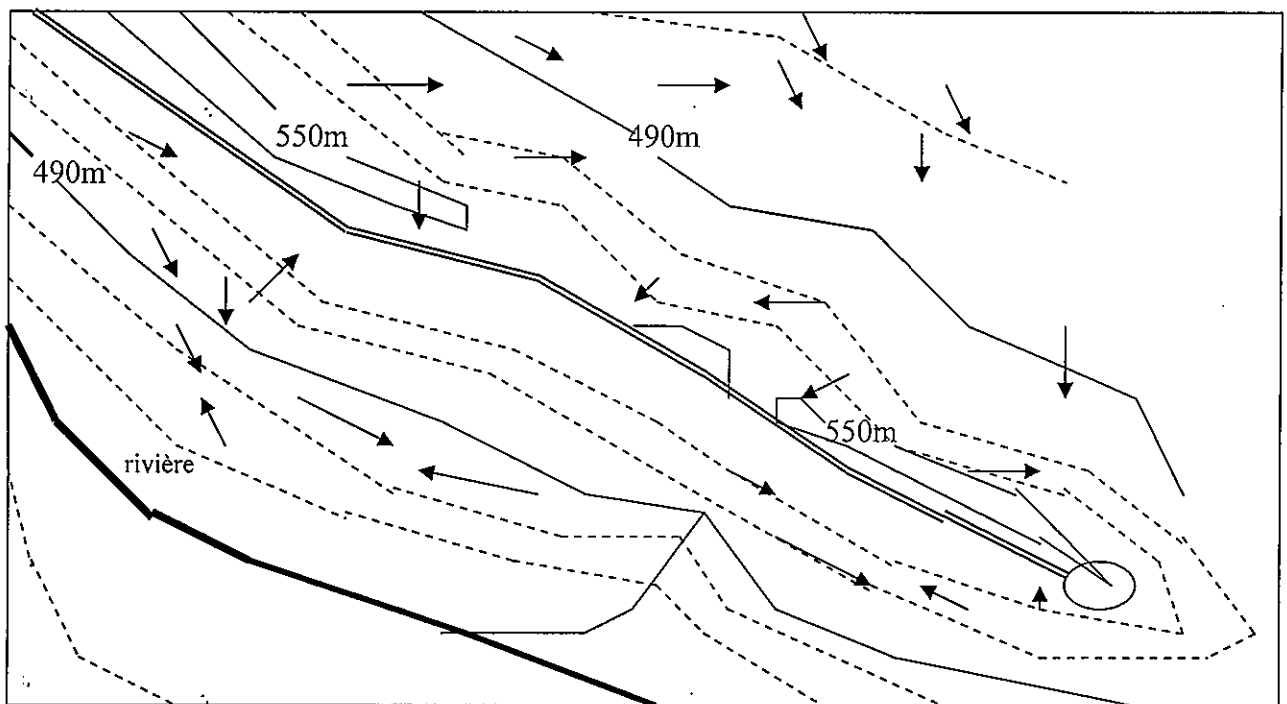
Exemple d'une planification sur carte d'un réseau routier
